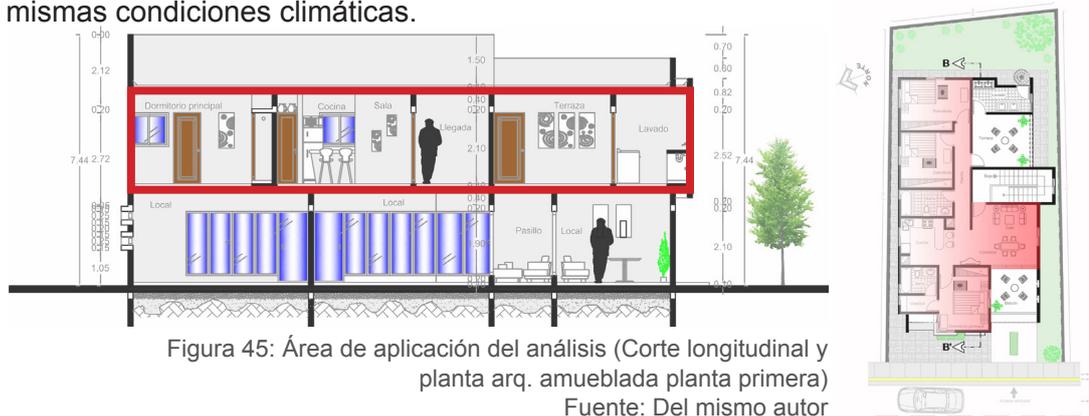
Área de aplicación del análisis (Corte longitudinal y planta arq. amueblada planta primera)
